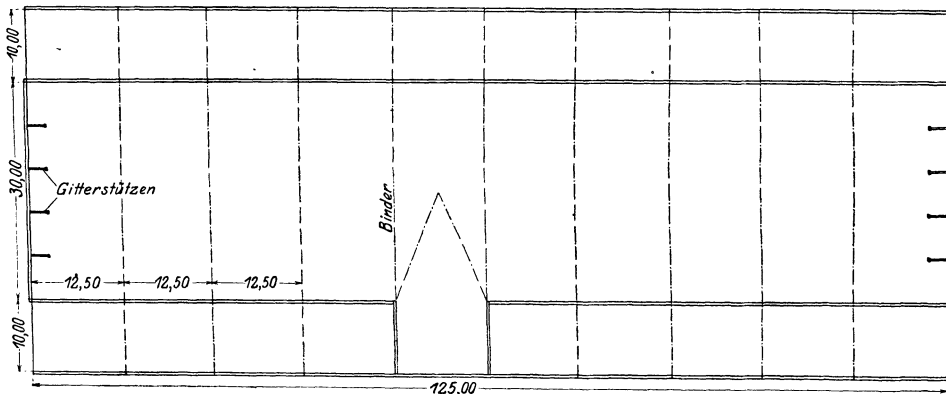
Grundriß der Ausstellungshalle Ludwigshafen.
